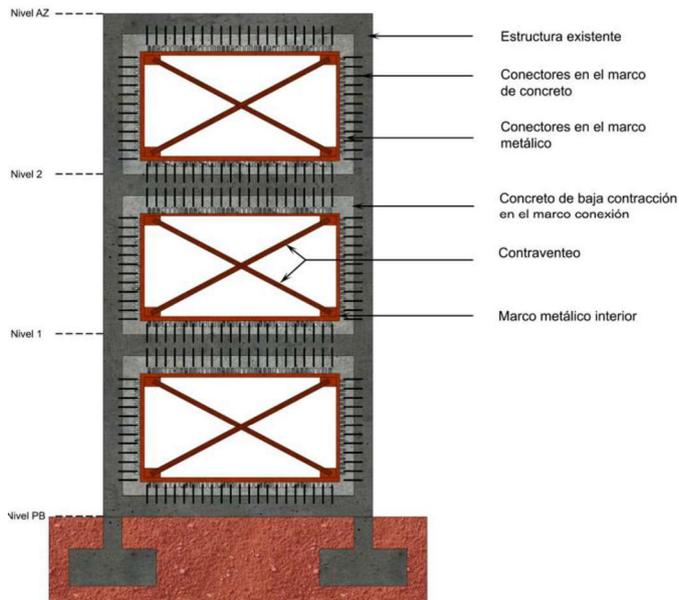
e – Contraventeo concéntrico en X dentro de la cruja de un marco de concreto (INIFED, 2021d)
